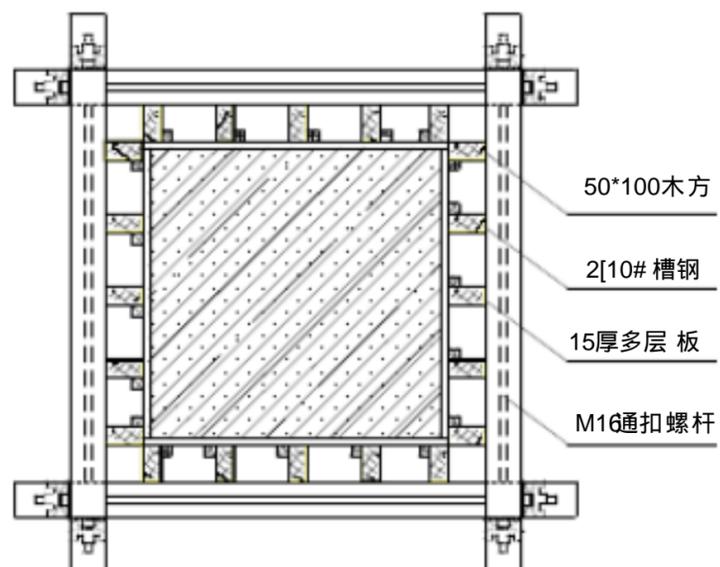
混凝土 柱构件的 木模板 示意图
